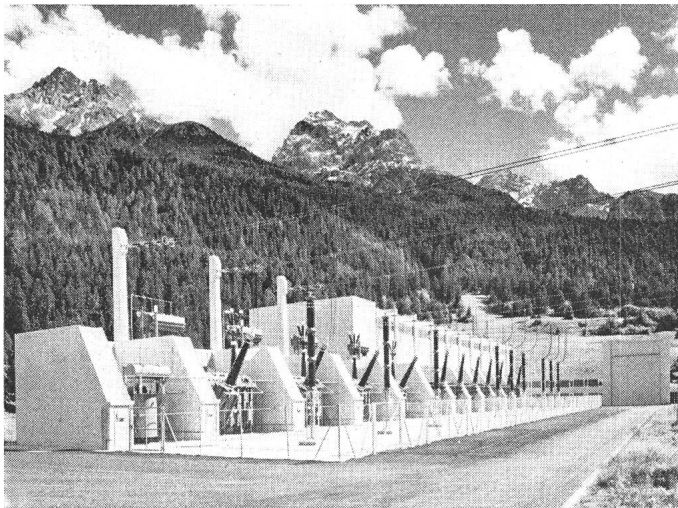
Maschinenhaus Pradella, Westfassade mit Transformatoren
